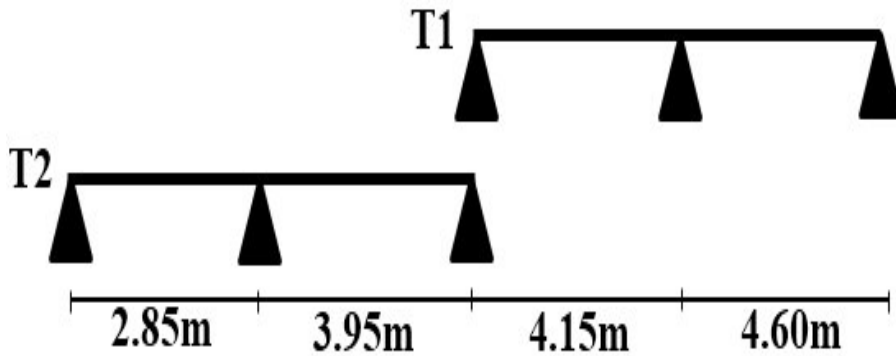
Différents types de poutrelles d'étages habitation et terrasse inaccessible.
